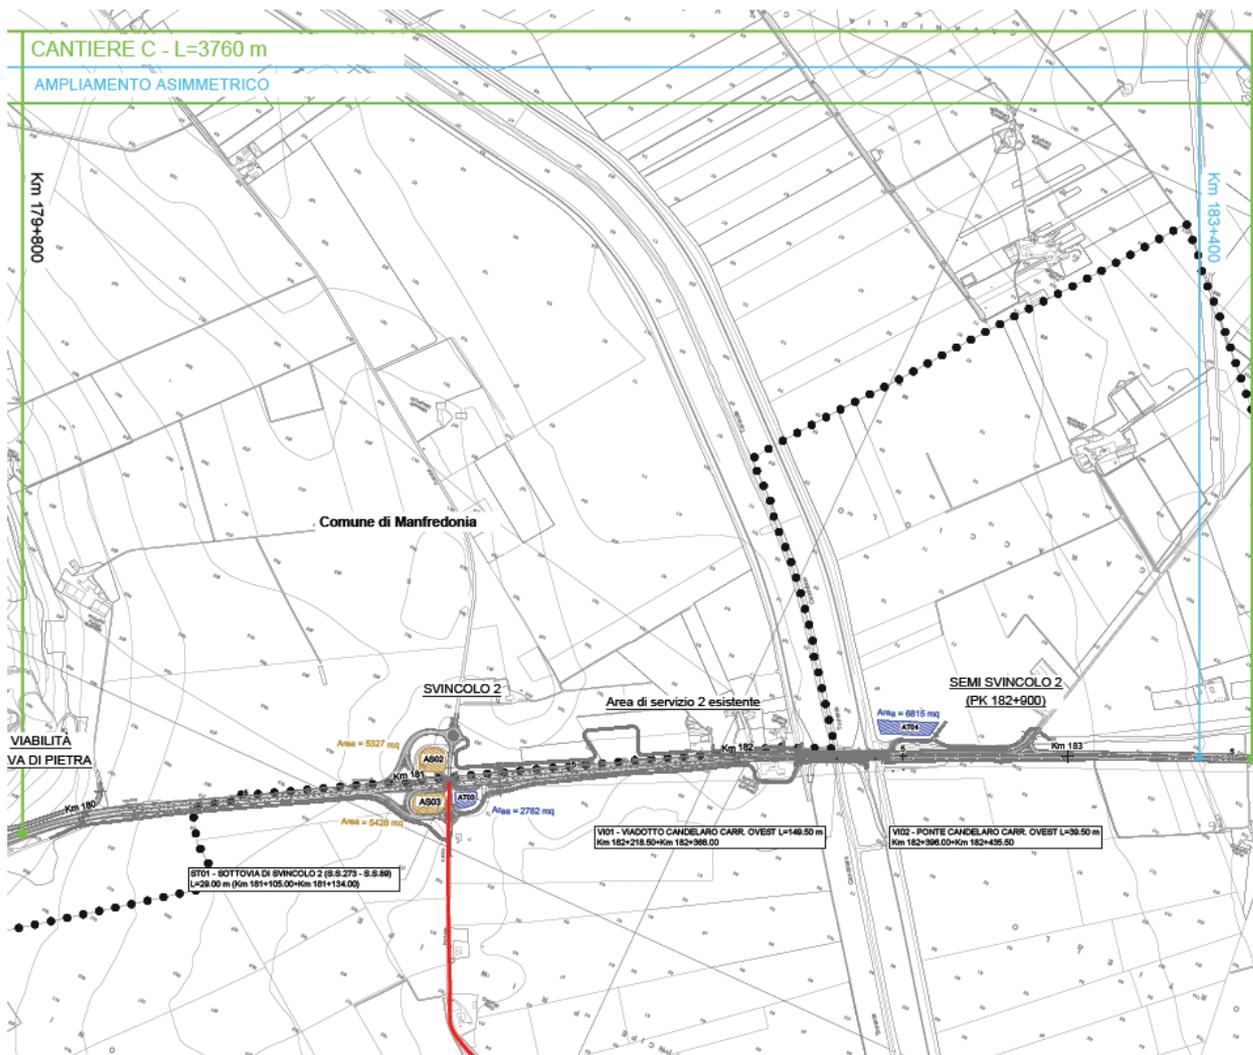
Stralci planimetrici con localizzazione Cantiere C
